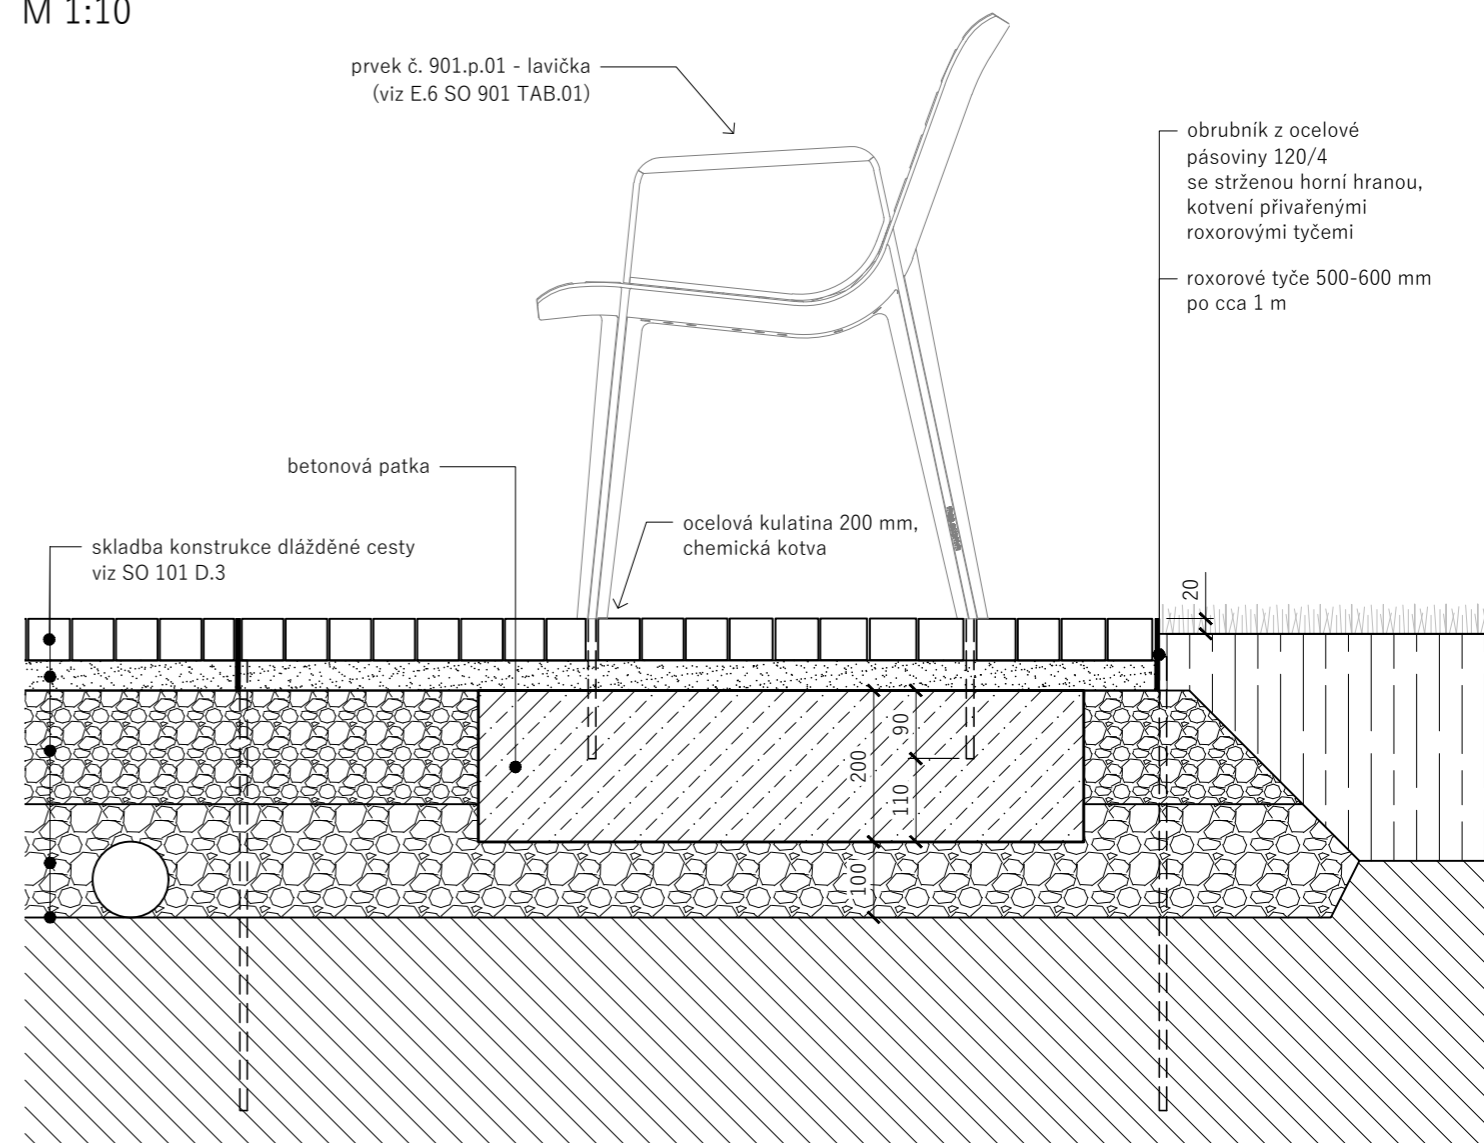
DETAIL KOTVENÍ PRVKU č. 901.p.01 LAVIČKA M 1:10
